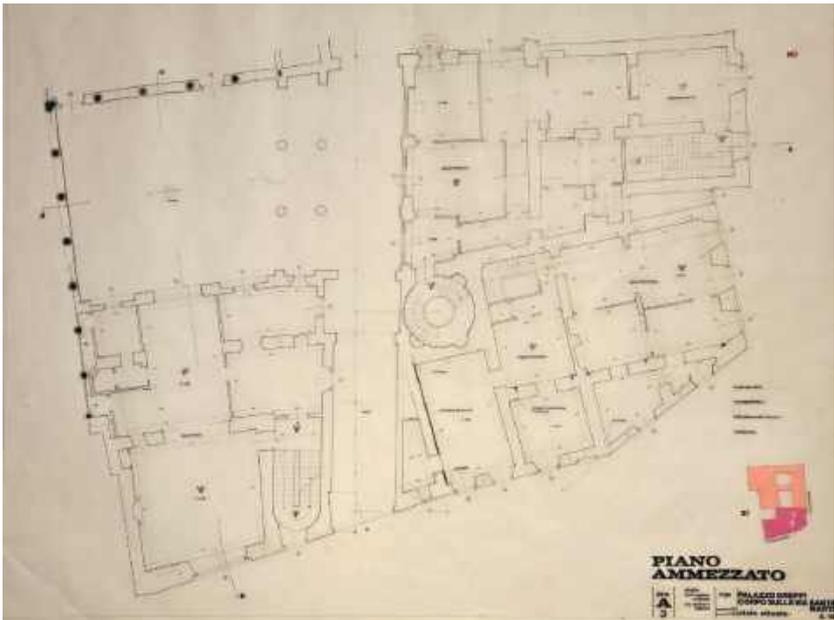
Corpo su via Santa Marta, pianta piano ammezzato, rilievo stato di fatto; tavola su lucido
